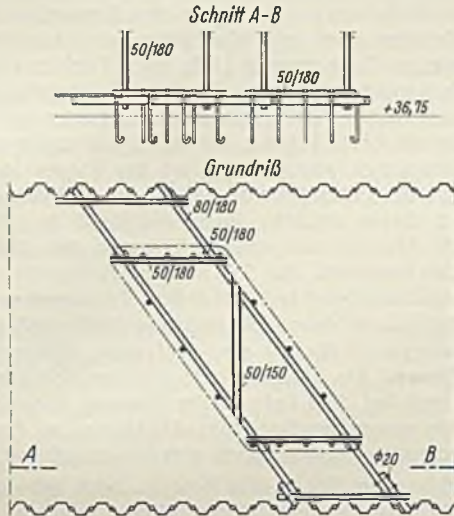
Rahmen zum Aufhängen der Rundisen. M. 1:60.
